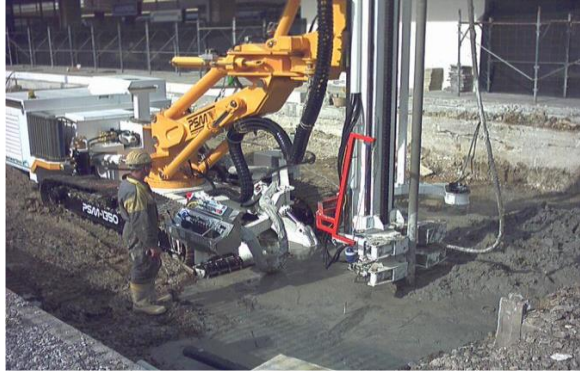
Execução de coluna de Jet Grouting (Fonte: sociedade portuguesa de fundações)
